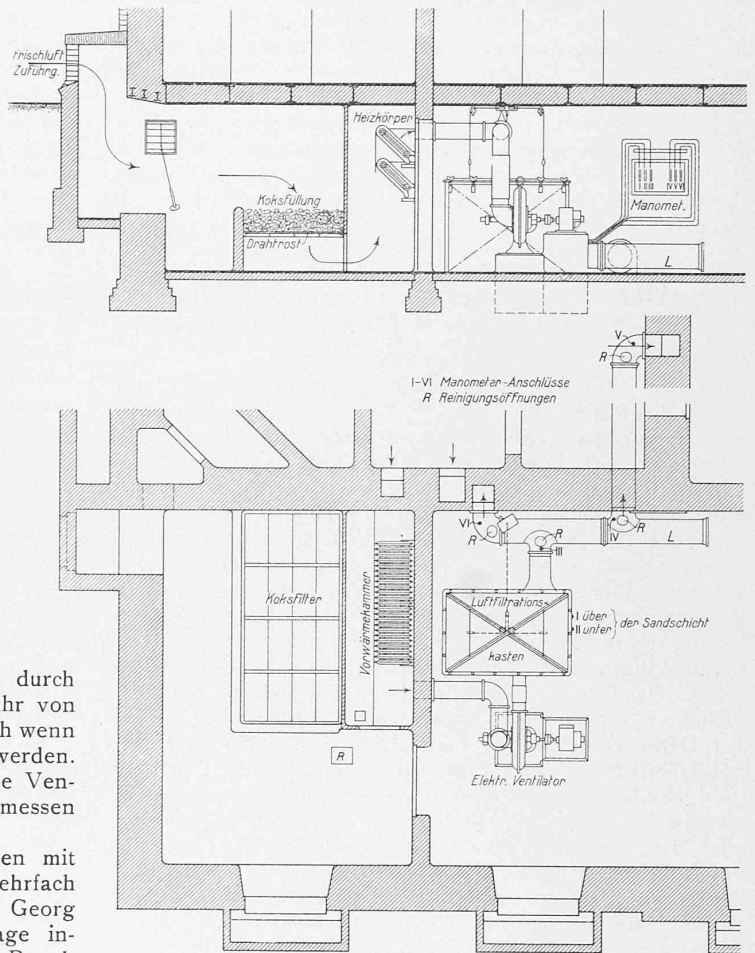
Luftfilteranlage für den aseptischen Operationssaal des Allgemeinen Krankenhauses Hamburg-St. Georg. Grundriss und Schnitt 1:100.
